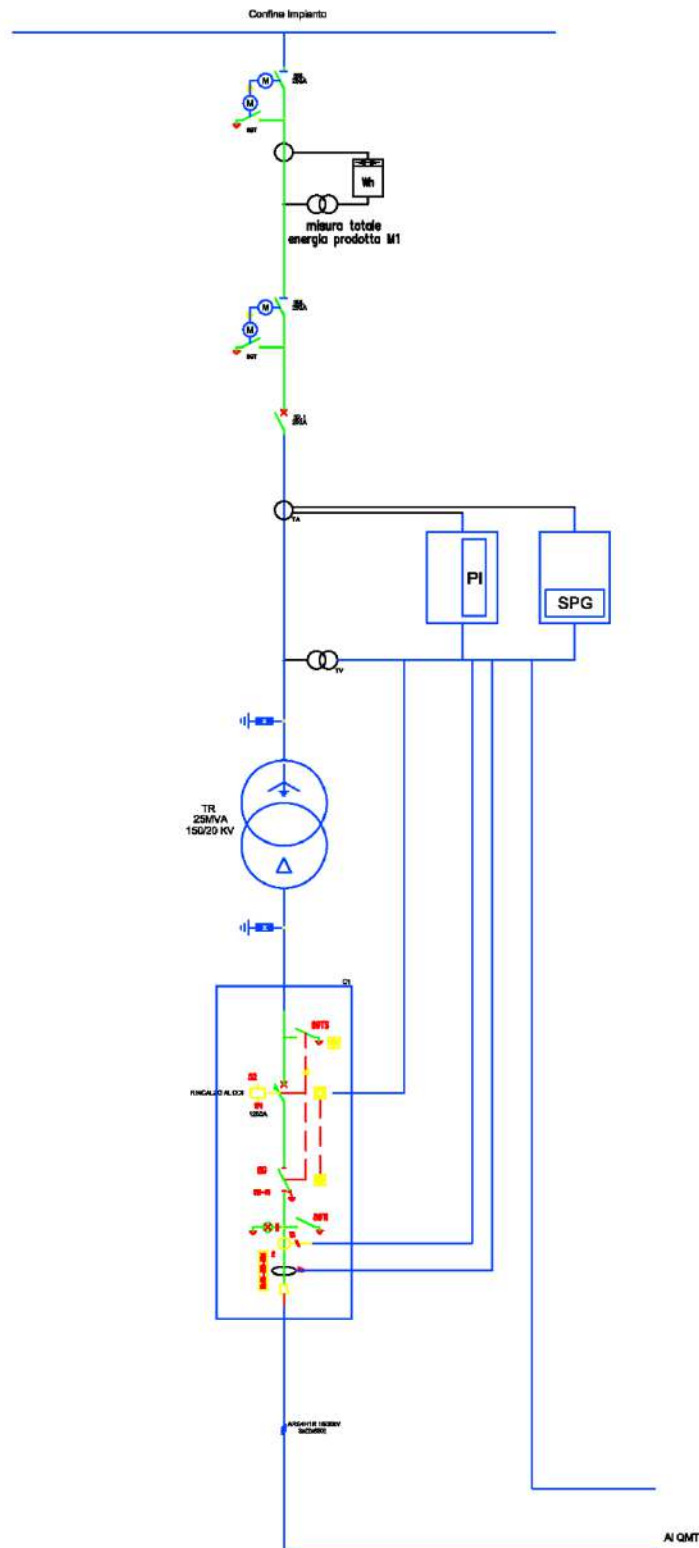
PARTICOLARE DI SCHEMA DELLA CABINA DI PARALLELO
